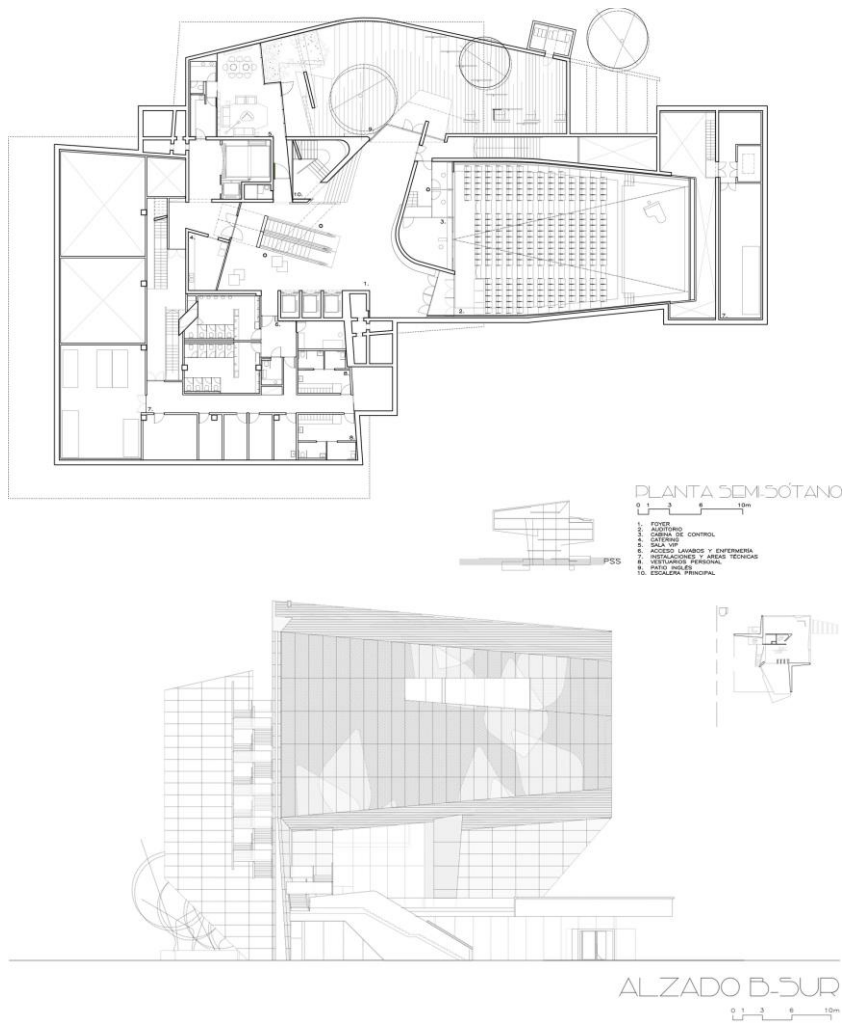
(Sup) Planta semisótano. Imagen (Inf) 2.18 Alzado B Sur.
